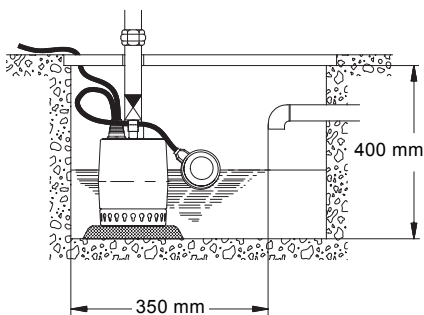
Dimensões mínimas do poço para a bomba Unilift KP-A
